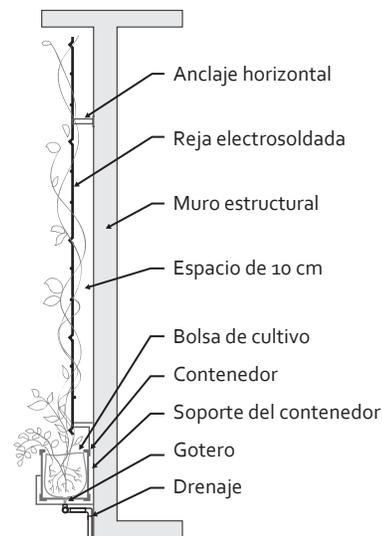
Fachada vegetada utilizando el sistema enrejado.
